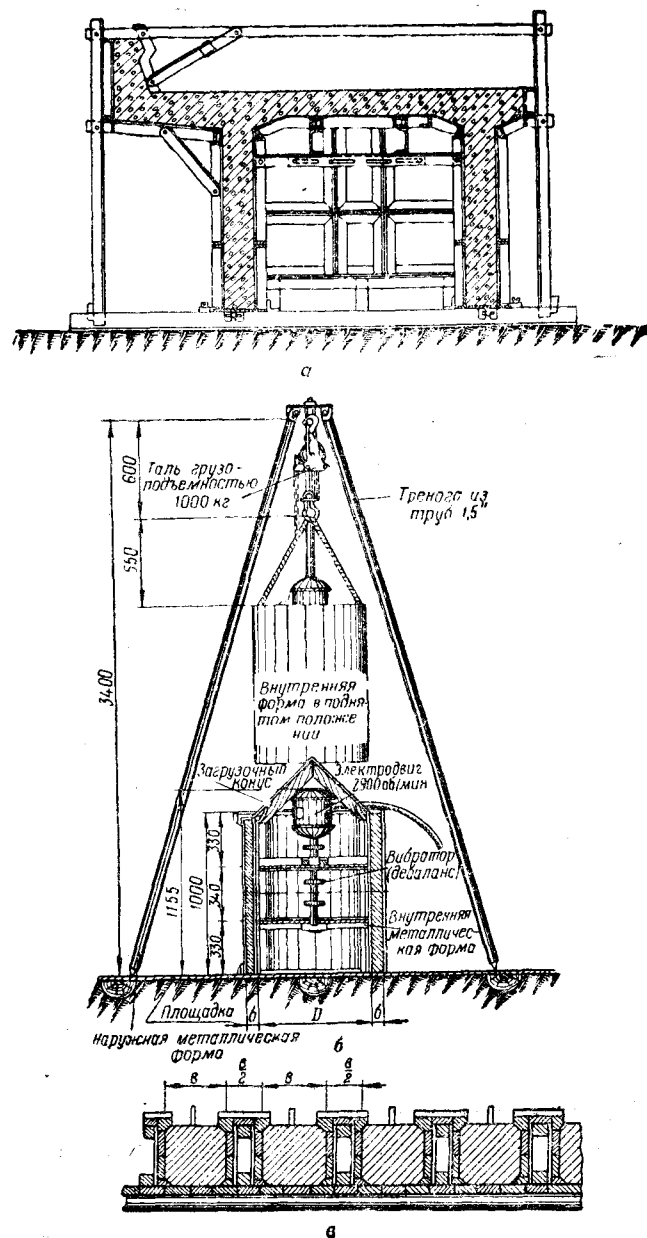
Типы металлической и деревянной разборной опалубки: а — для изготовления пролетных строений; б — виброформа для изготовления звеньев труб; в — для изготовления железобетонных свай
